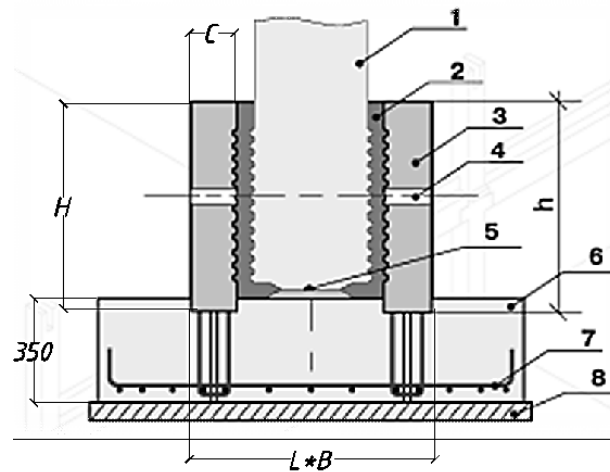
Конструкція збірно-монолітного фундаменту (КТР-Ф3):
